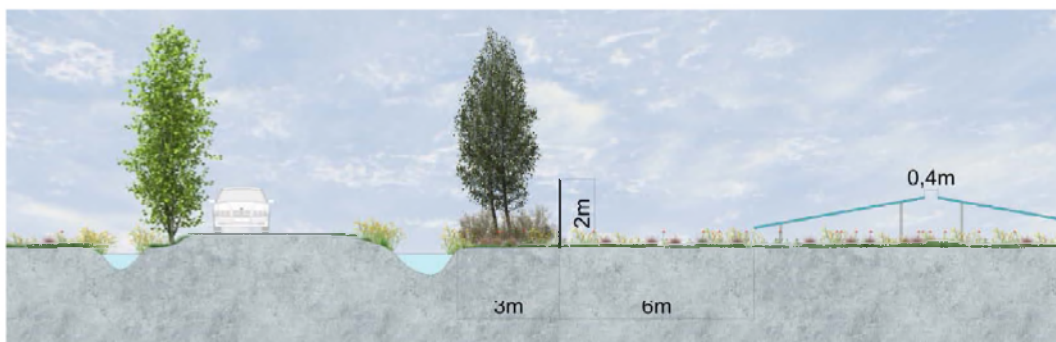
Doorsnede (1) noord-zuid met ruimte langs watergang: wandelen, onderhoud en beplanting
